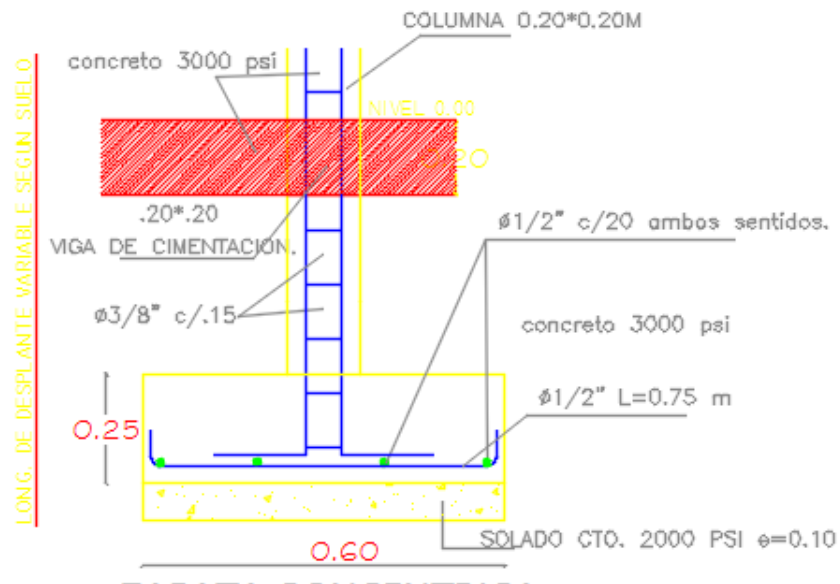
Detalle estructural zapata - cerramiento contrato 1302-2015.
